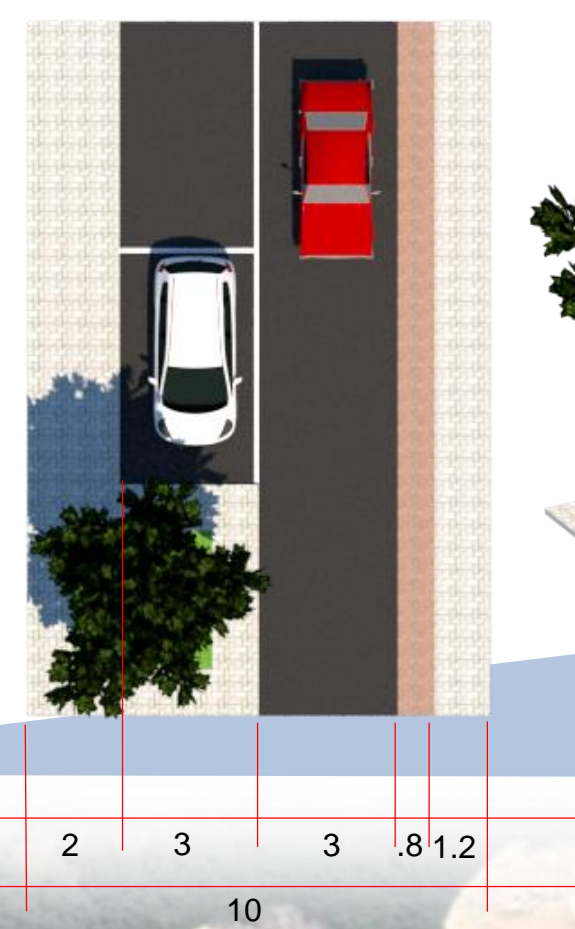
e 47 – Planta e Perspectiva Fonte: Autor.
